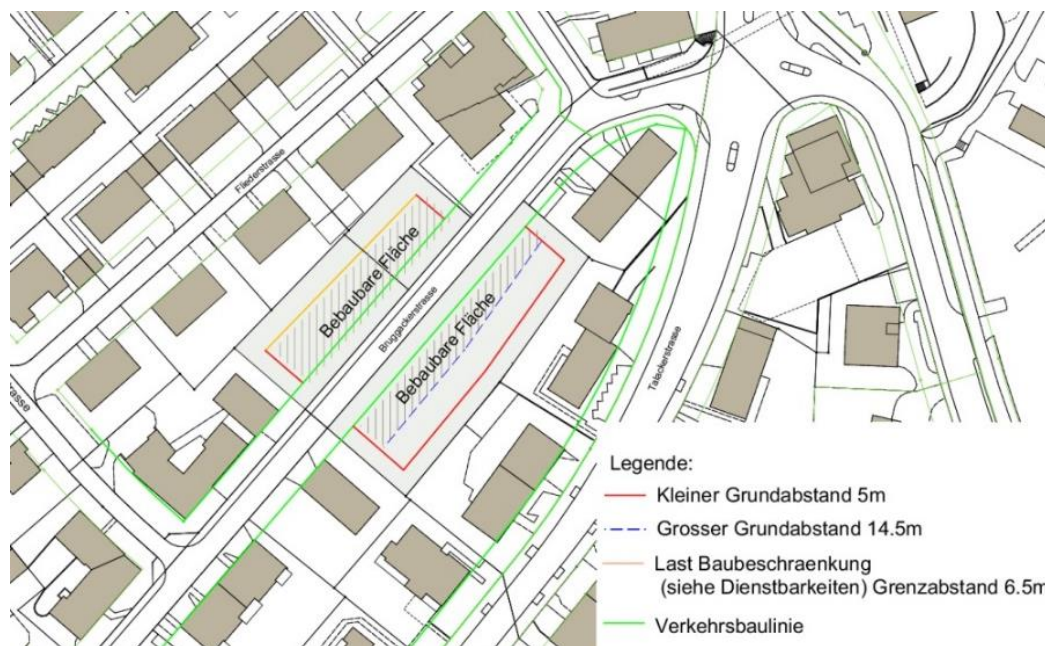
; Katasterplan mit bebaubarer Fläche mit grossem Grundabstand gemäss BZO, Machbarkeitsstudie vom 20.12.17
